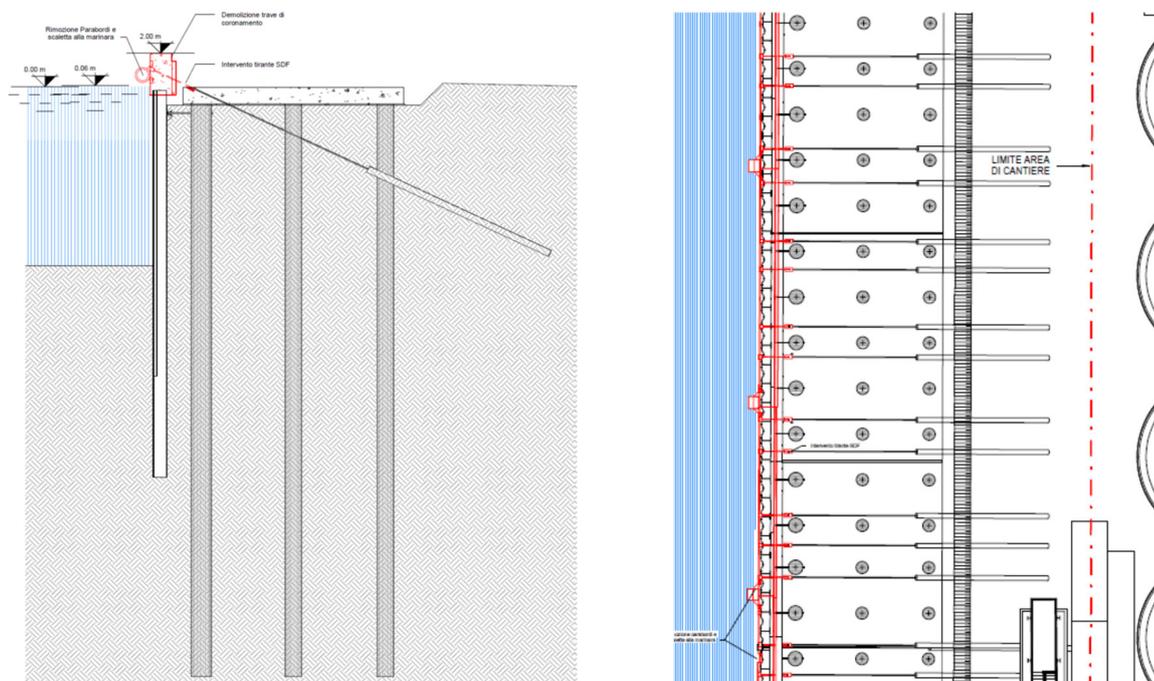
Banchina Bunge Sud – Fase 7 – Sezione e planimetria
